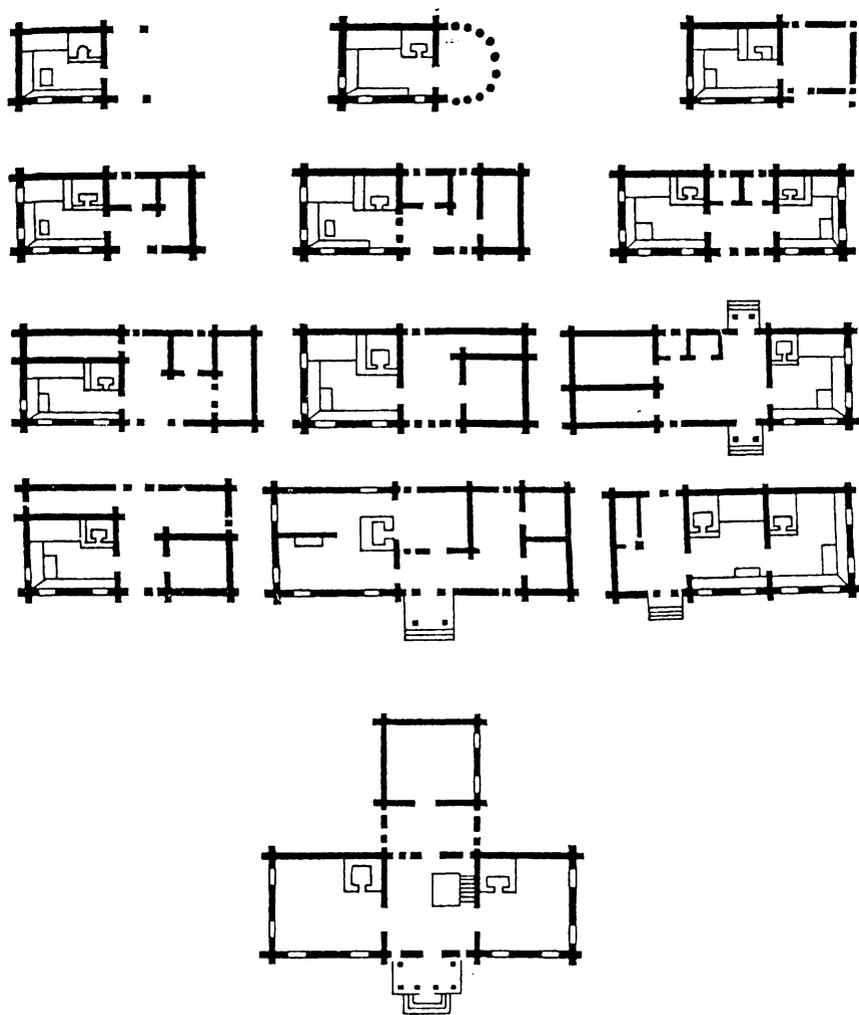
Планировочные схемы жилых домов белорусских крестьян (по А.И. Локотко)
